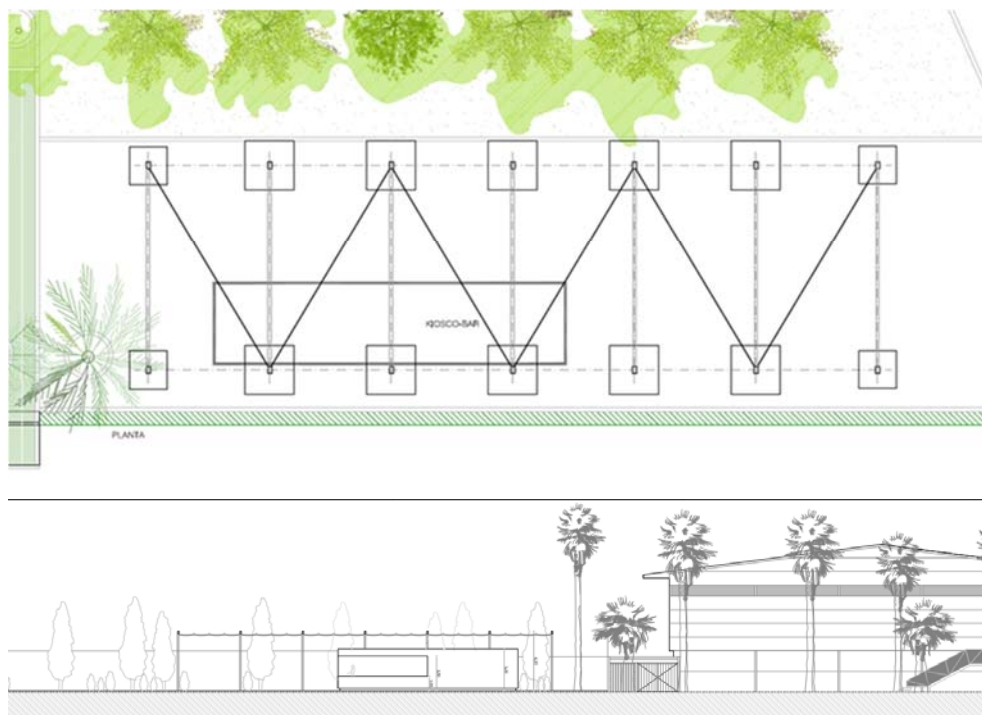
Planta y sección tipo futura de la zona de actuación
